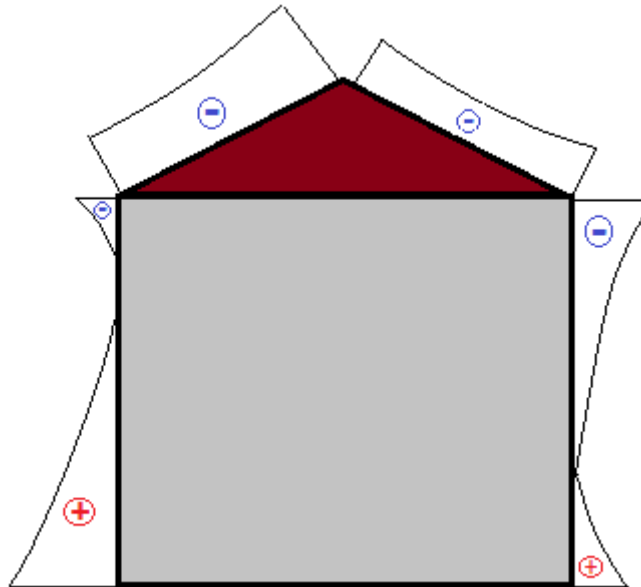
Pressões típicas nas fachadas de um edifício pela acção térmica e pela acção do vento (Adaptado de Amaral, 2008).
